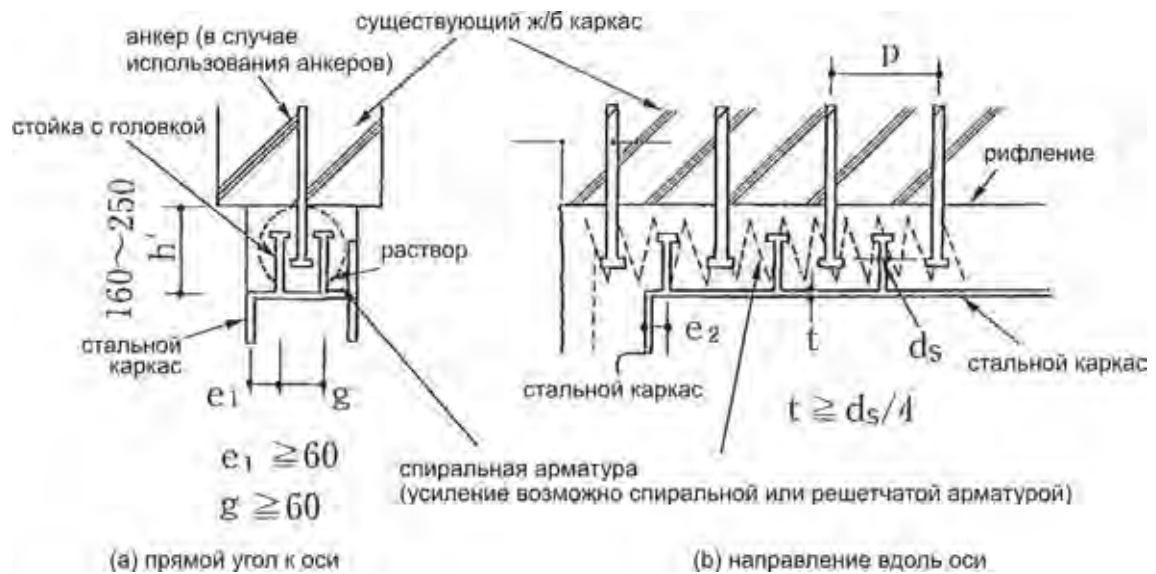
Схема крепления (соединения) металлической рамы к существующему железобетонному каркасу здания
